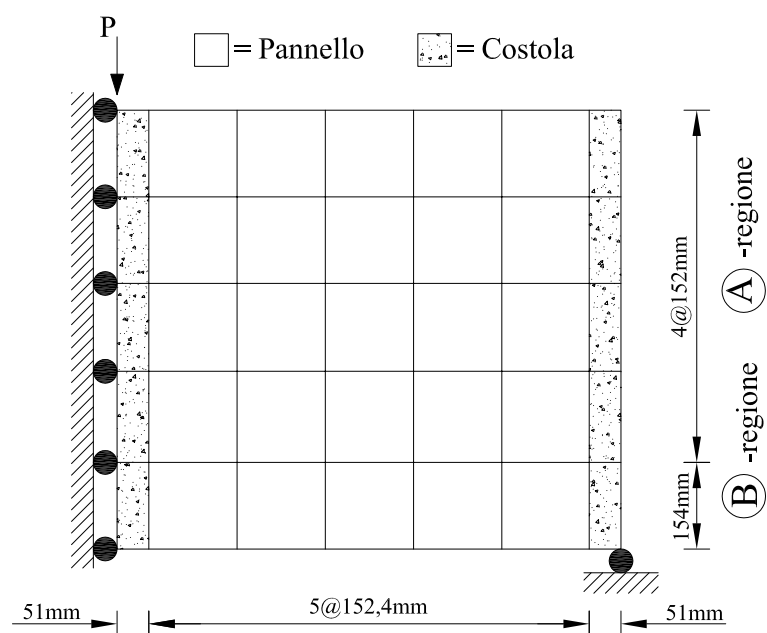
Suddivisione agli elementi finiti del pannello W-2
